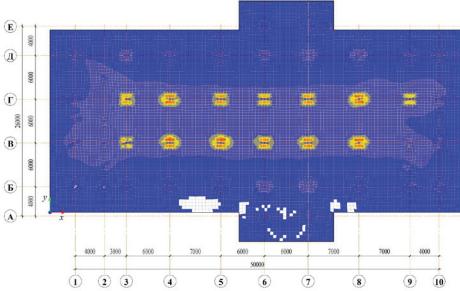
Цементно-грунтовое основание толщиной 6 м ($E = 15$ МПа). Карта нижнего армирования фундаментной плиты по оси « Y ». Требуемая площадь рабочей арматуры от 4,73 см²/м (5Ø12) до 9,45 см²/м (5Ø16)
